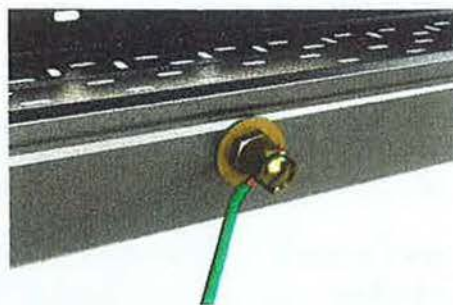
Detalle de conexión a tierra de una bandeja metálica.
